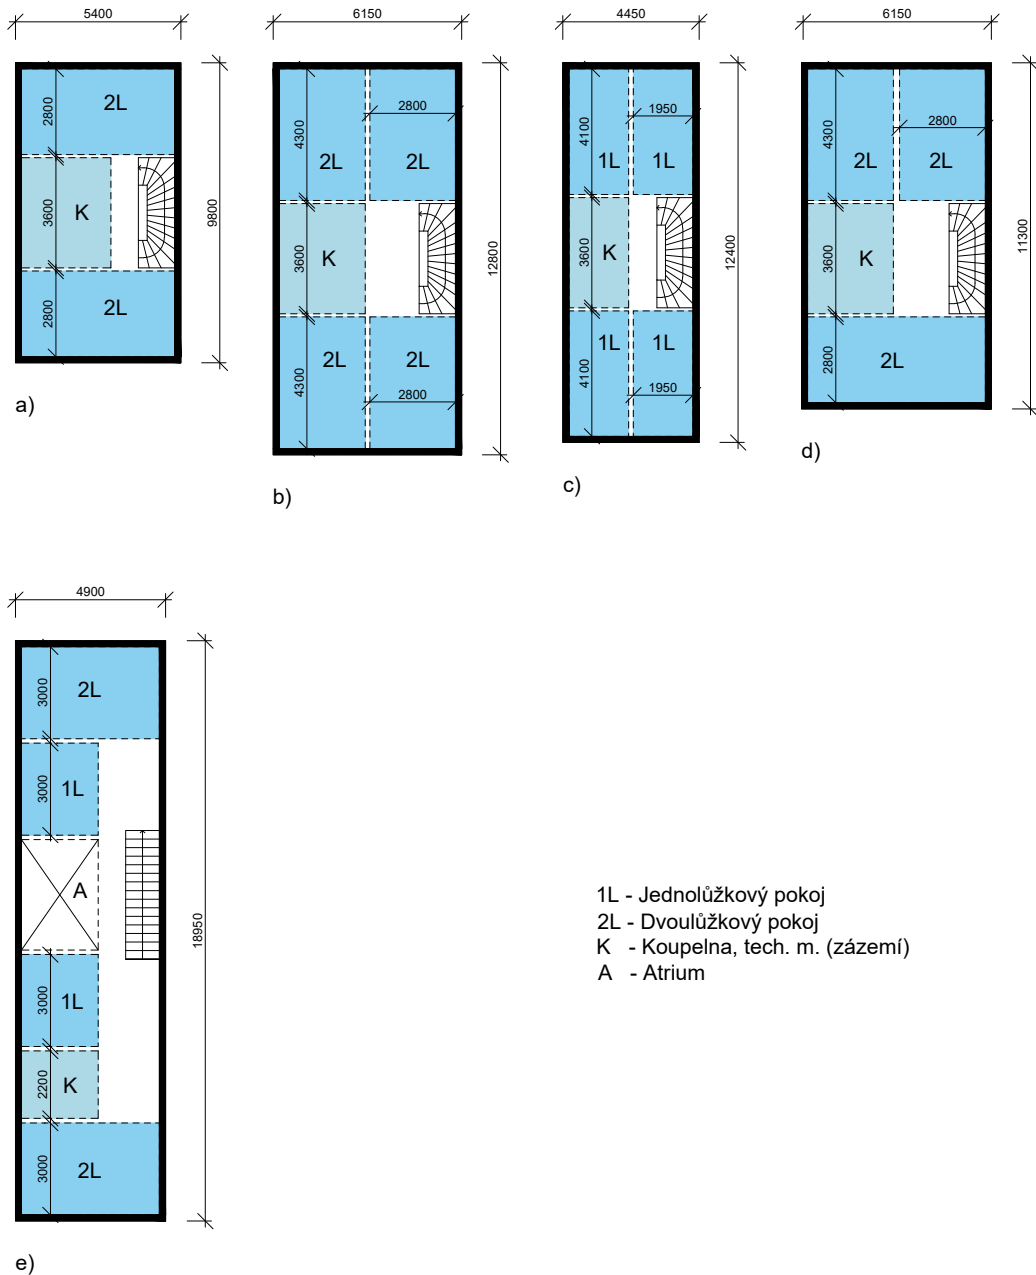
Šířka townhousu (Zdroj: autor Erik Petrus)
